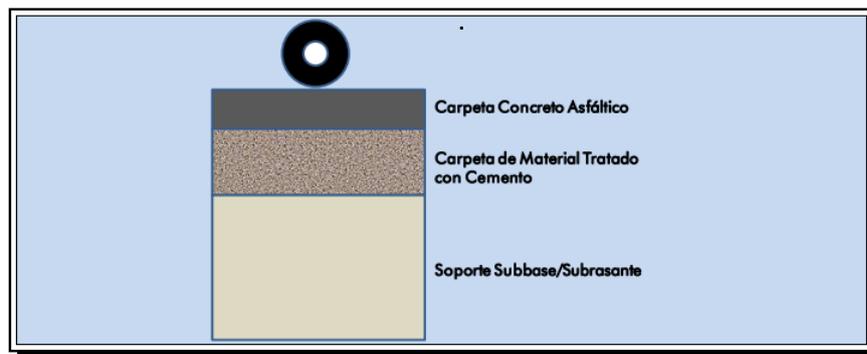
diseño de pavimento semirrígido, fuente: Escalante et al., (2017).
